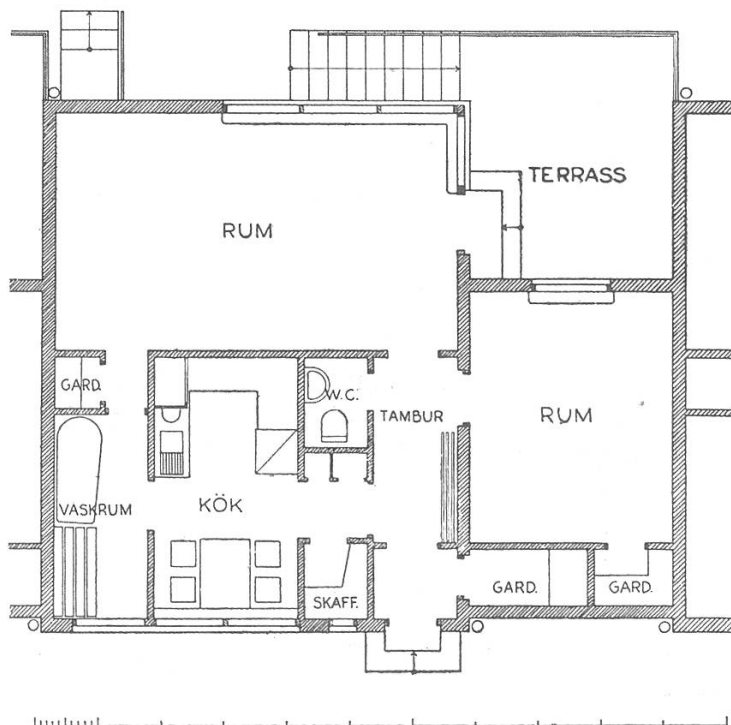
Plan des Reihenhauses. Wohnzimmer in Südlage  $4 \times 7,4$  m, Gesamtmass eines Hauses  $8,3 \times 10$  m. Badezimmer und Waschküche kombiniert. Statt der Garderobe rechts vom Eingang kann bei künftiger Aufstockung eine Treppe ins Obergeschoss angeordnet werden.
